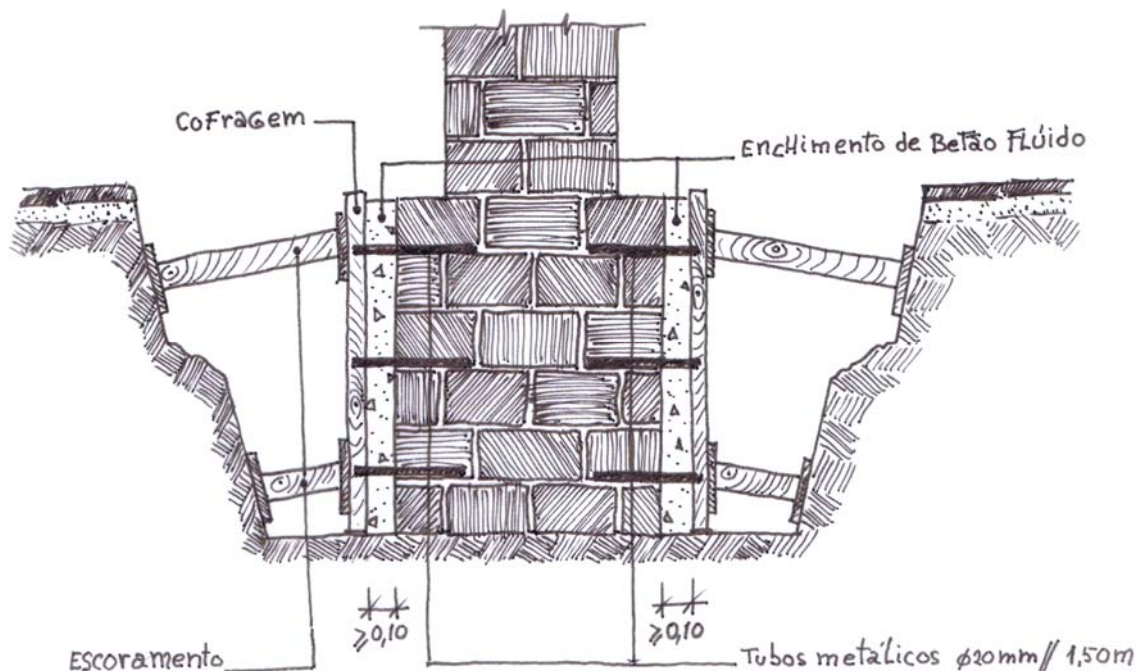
| Alargamento de fundação com enchimento de betão, sua consolidação prévia com injeção de ligantes, e seu confinamento, com ou sem “grampagem” metálica de reforço (adaptado de [13]).
